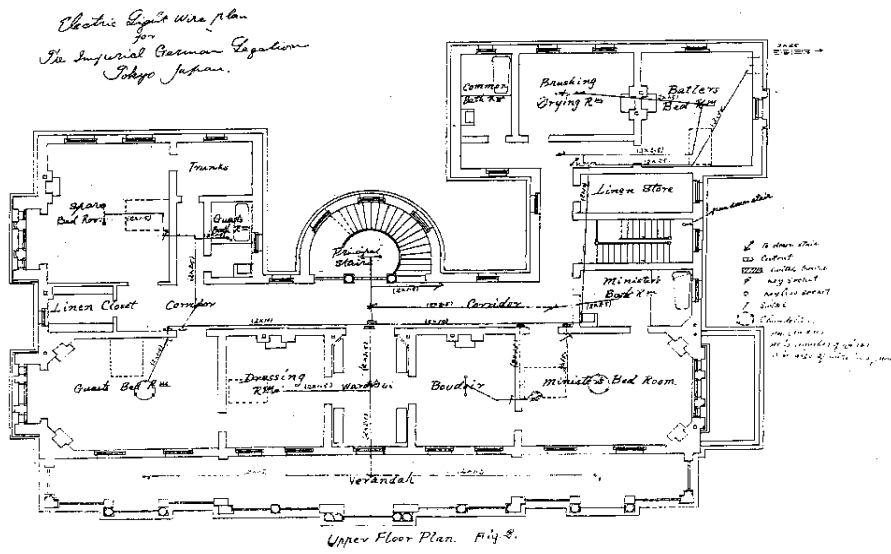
Grundriß des Gesandtschaftsgebäudes (Obergeschoß)
